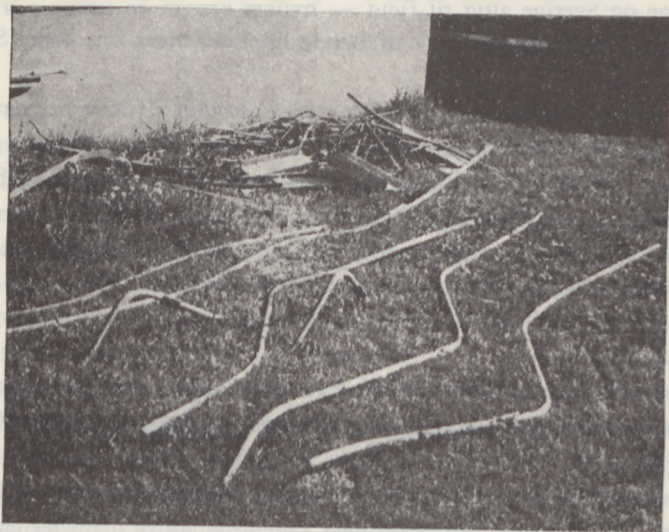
Overbelastede Ø 25 mm stål-pæle
